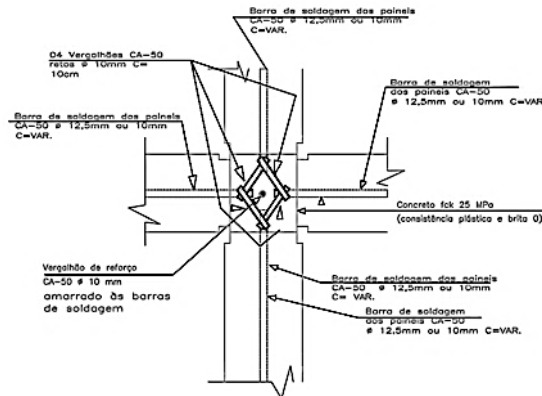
Detalhe esquemático da ligação entre quatro painéis.
